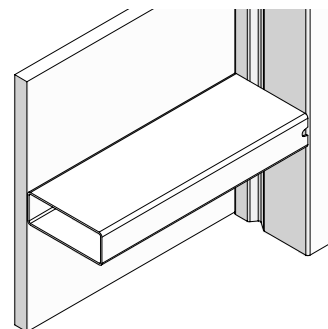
Refuerzo transversal de acero (sin perfil de agarre)
